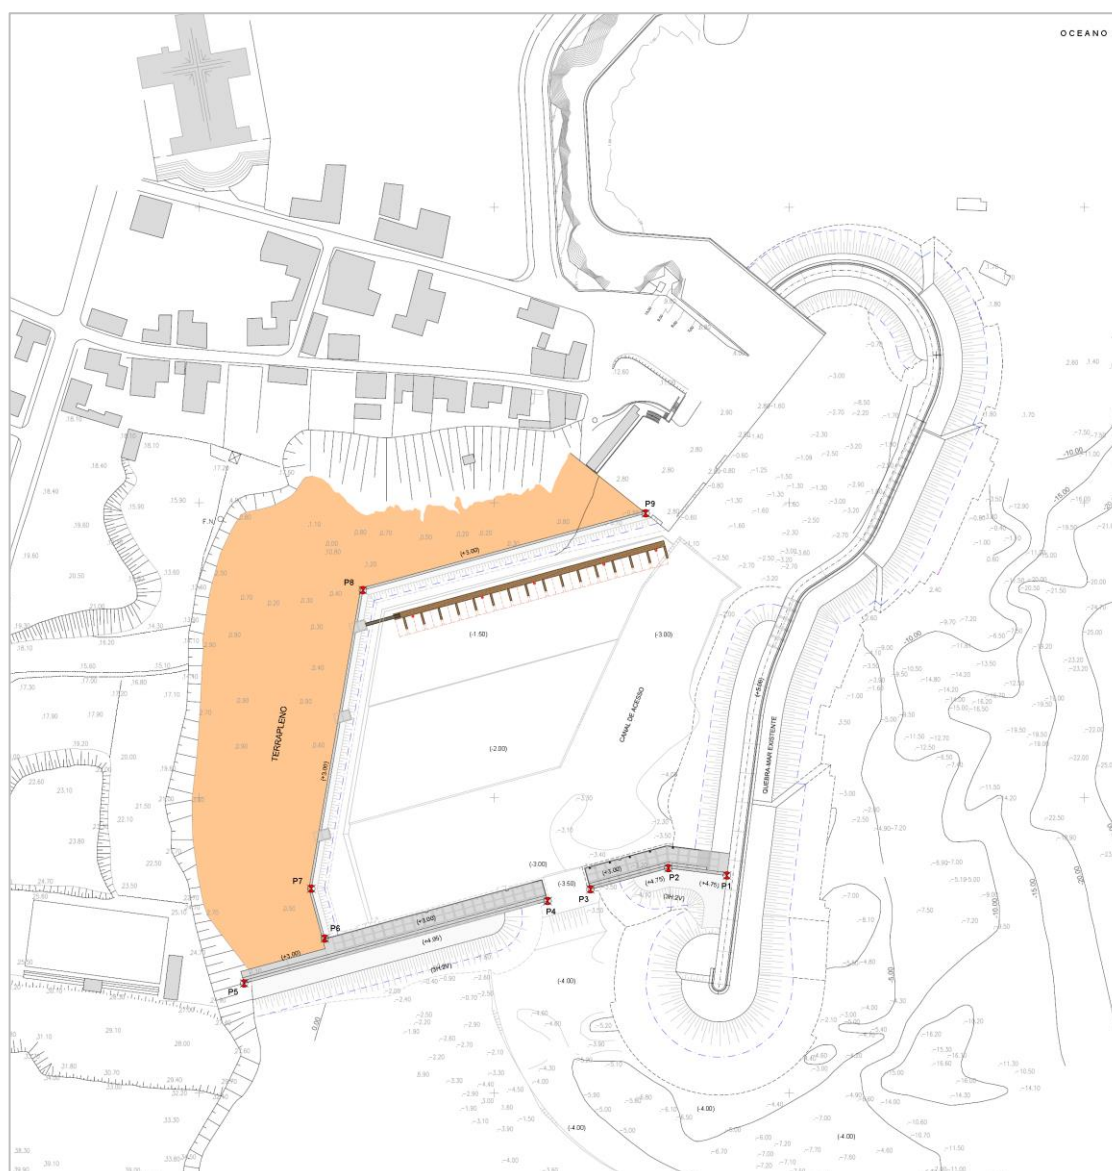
Planta geral das obras de melhoramento do Porto das Poças
